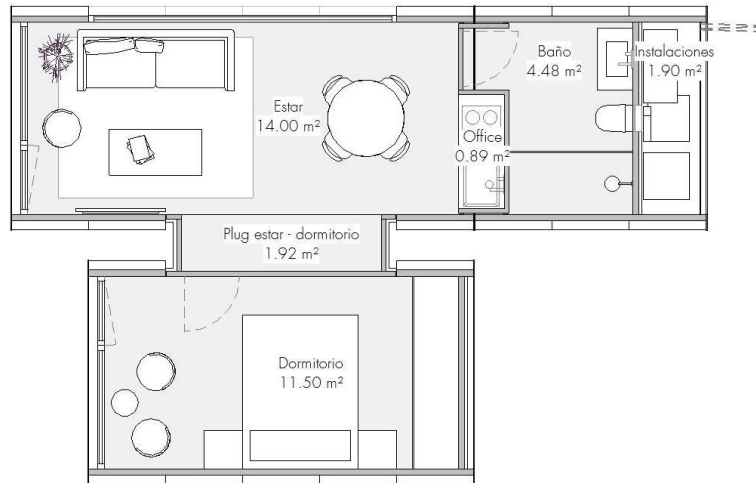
Minimal haus. Prototipo de 3 módulos, planta. Fuente: Metro7 (2021)
